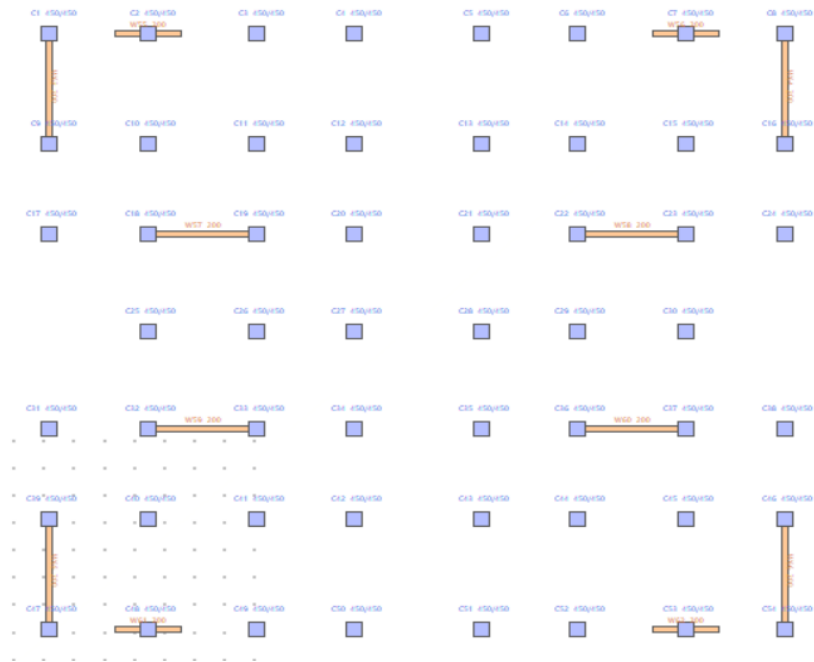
Plan en vue en dessous du niveau 1 de la structure à appuis fixes
